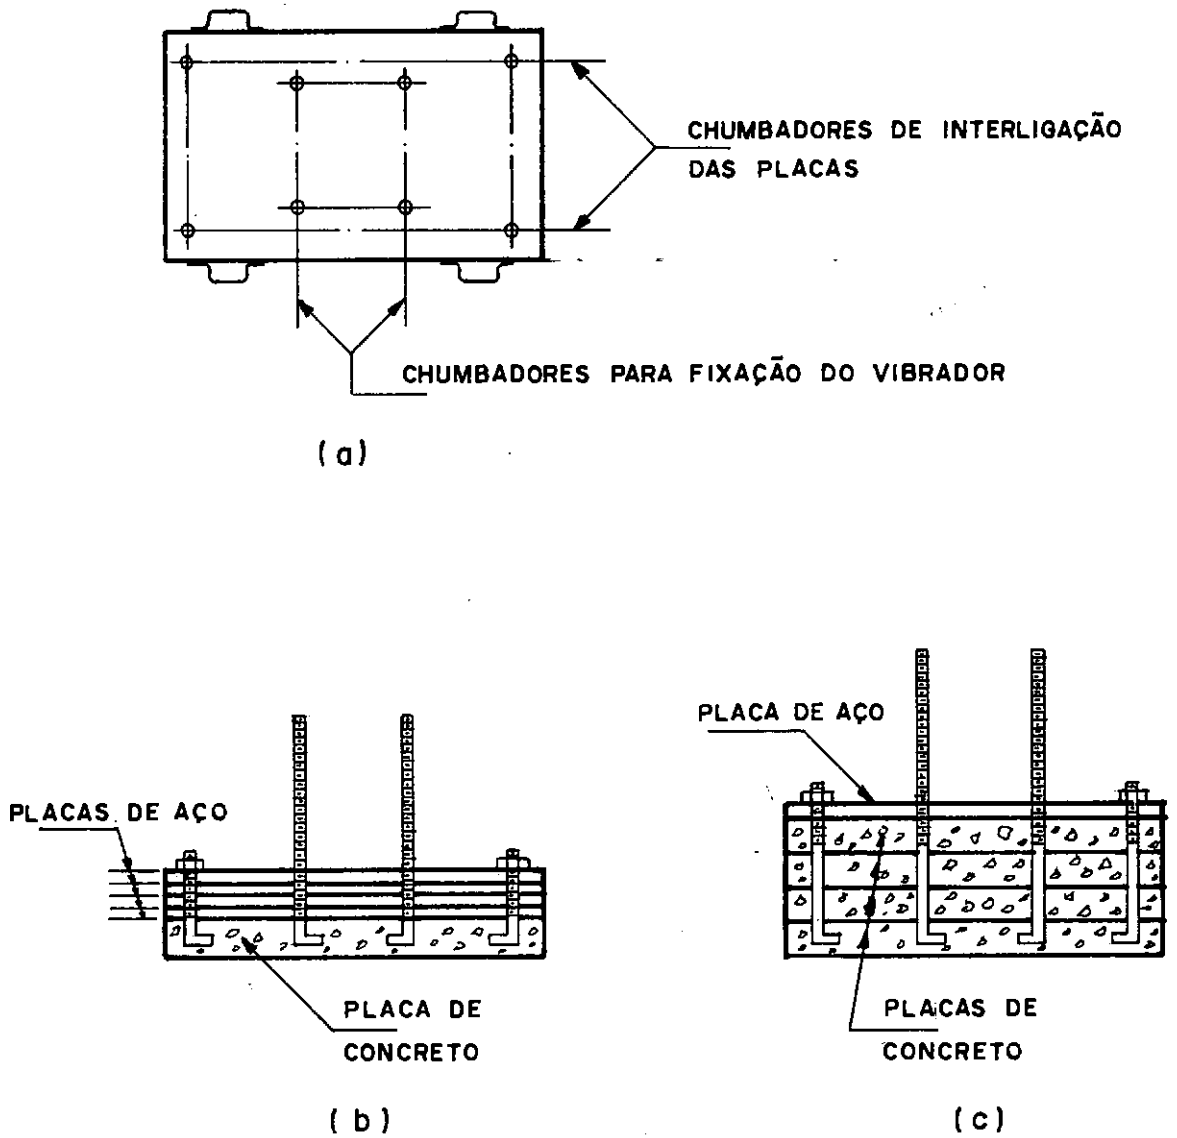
Bloco de ensaio do tipo placas: (a) planta e plano dos chumbadores; (b) para a vibração vertical; (c) para a vibração horizontal (apud Ivanoff, 1963).
